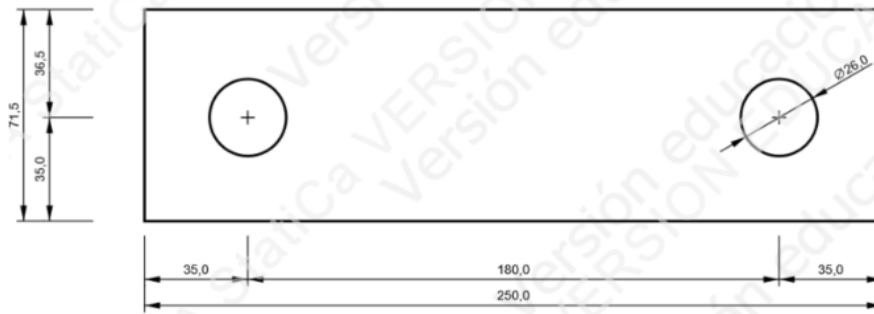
Placa de refuerzo de la unión de IPE300 sin cartela
